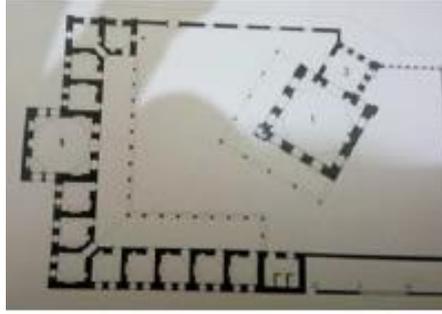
مسقط أفقي للمسجد الملحق بمدرسة أنجة منار لي بقونية
